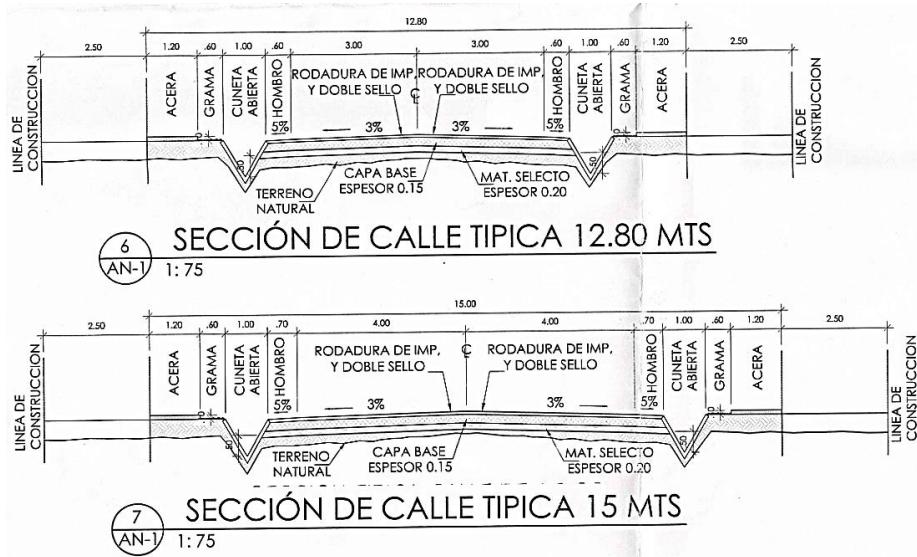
Detalle (sección de calle típica) de Avenida y calles.
